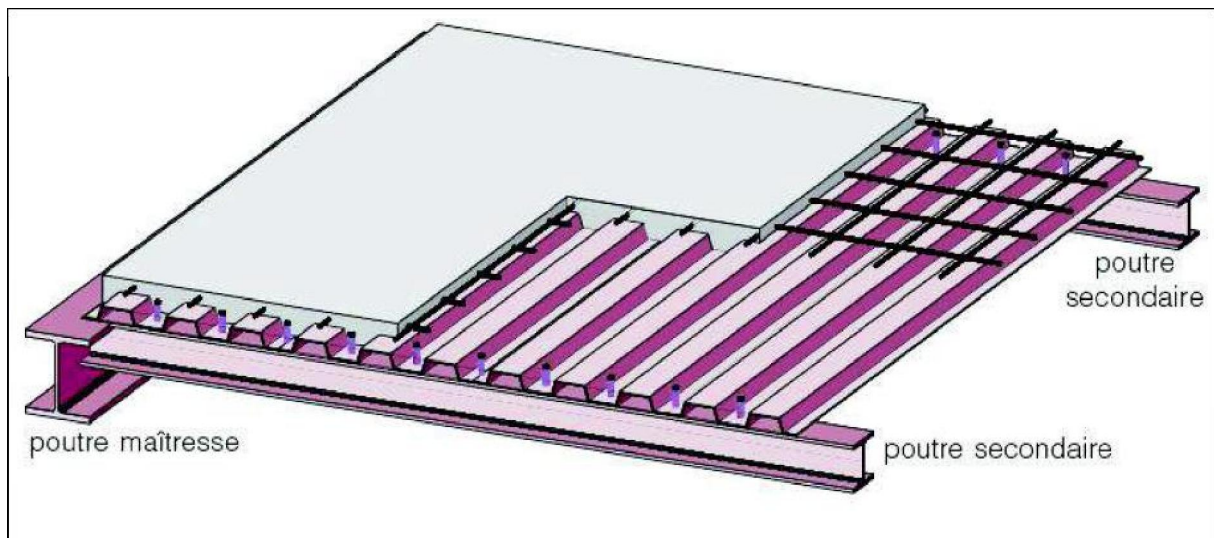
Vue d'une structure mixte acier-béton avec dalle mixte
